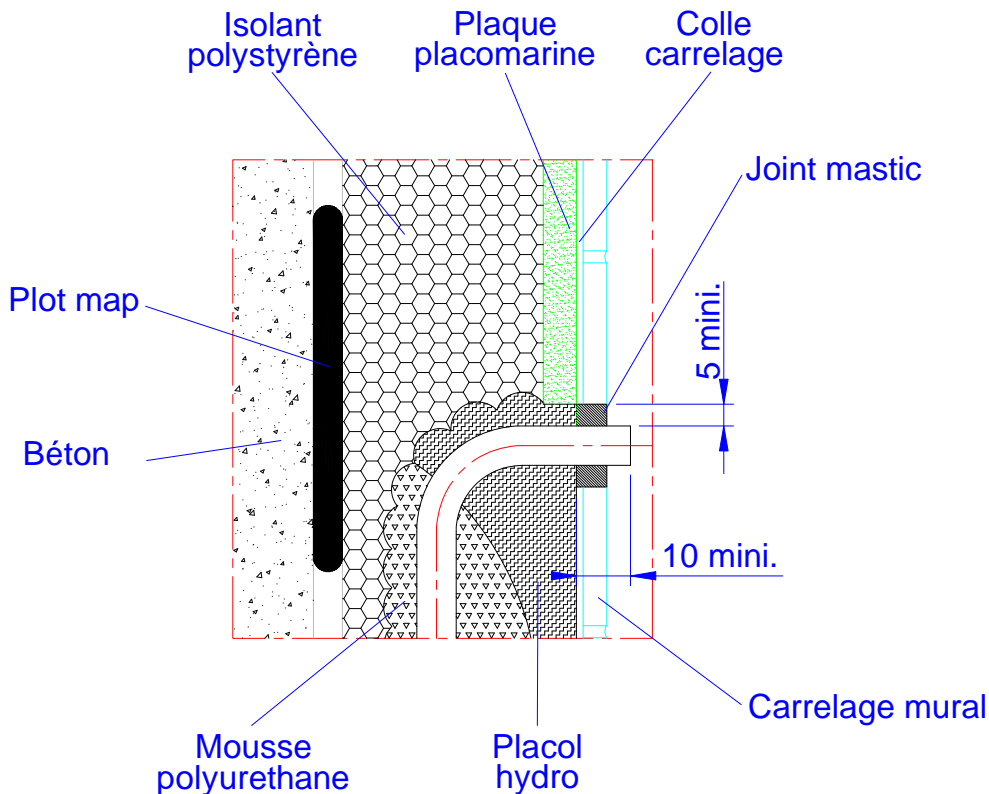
Exemple d'arrivée d'alimentation d'eau au dessus d'un appareil sanitaire, dans un doublage - local EB+ Privatif – coupe verticale
